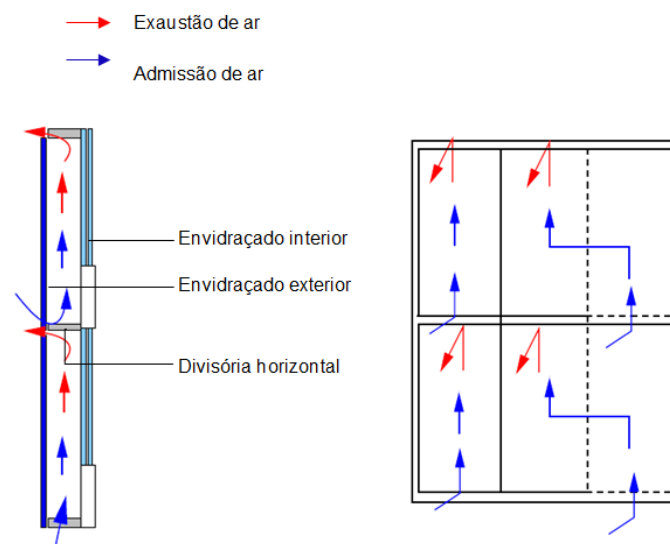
Geometria e esquema geral de ventilação de uma fachada do tipo "Confinada" (vista frontal e corte em perfil) (adaptado de Faggembauu, 2006).
